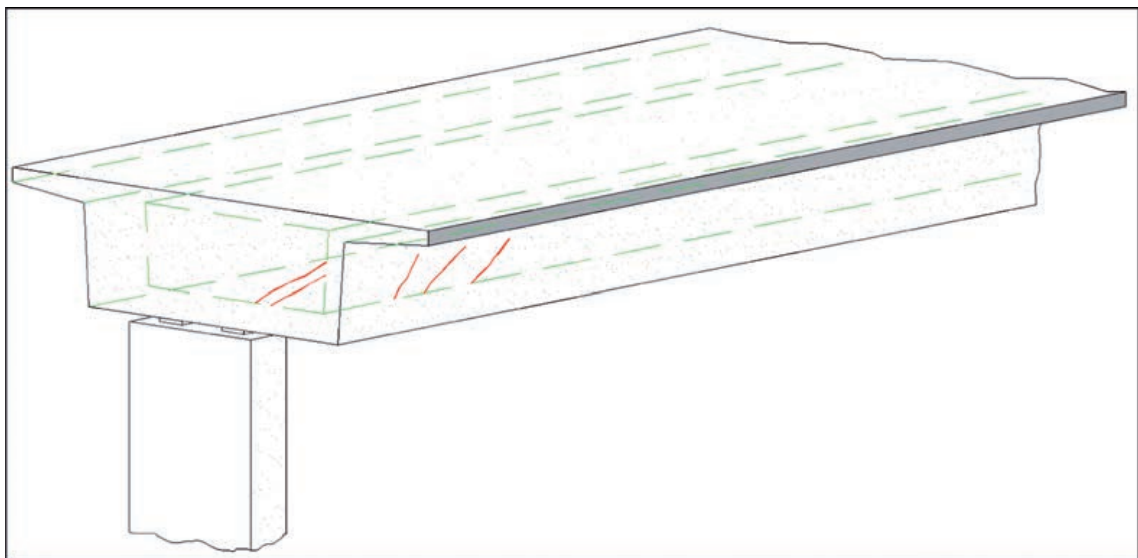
FISURAS DE CORTANTE ORIGINADAS POR LA EXCENTRICIDAD DE LOS APOYOS RESPECTO DEL PLANO MEDIO DE LAS ALMAS.
